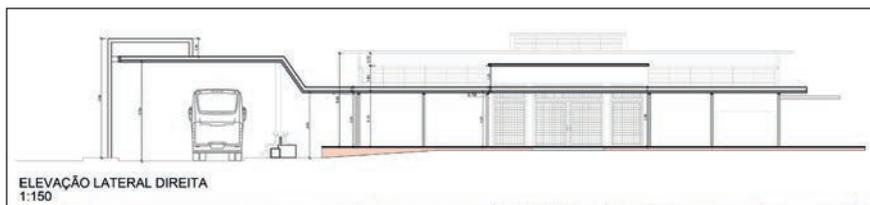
Planta de arquitetura com a proposta do terminal urbano dentro da edificação existente
